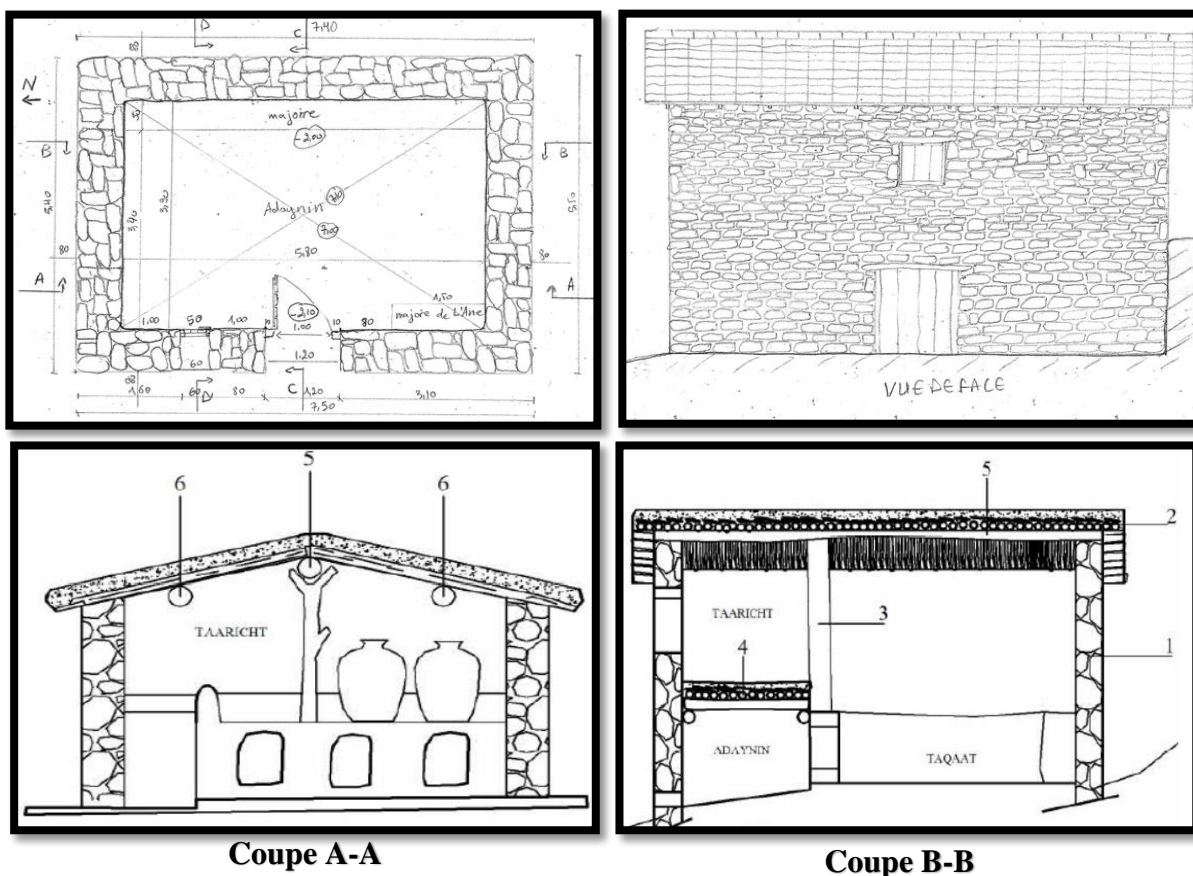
Relevée , facades et coupe d'une maison kabyle dessiné par l'auteur
